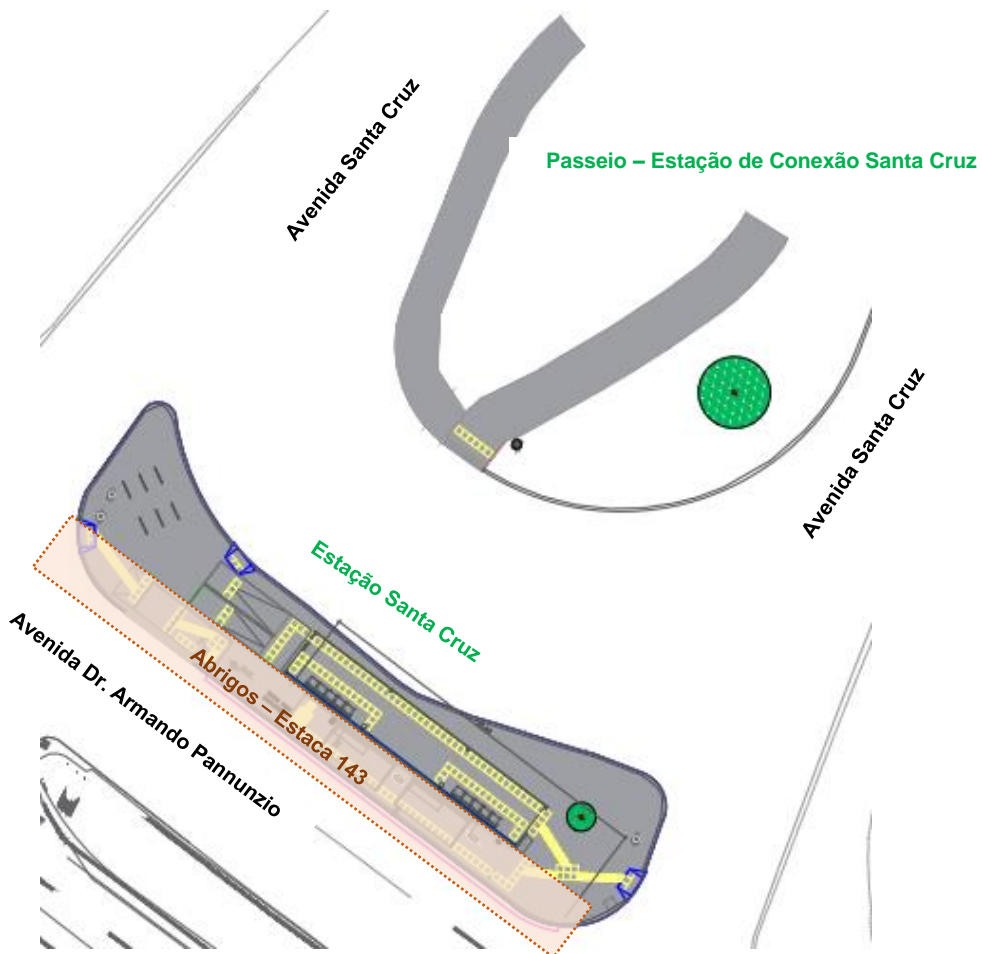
Planta de Arquitetura do Abrigo e da Estação Santa Cruz (DE-IP-090-014-02 – rev.2).
